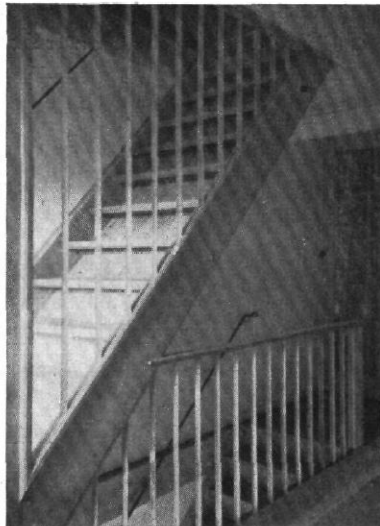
| Haustyp F | Treppe vom Obergeschoß zum Dachgeschoß über der Hauptgeschoßstreppe
